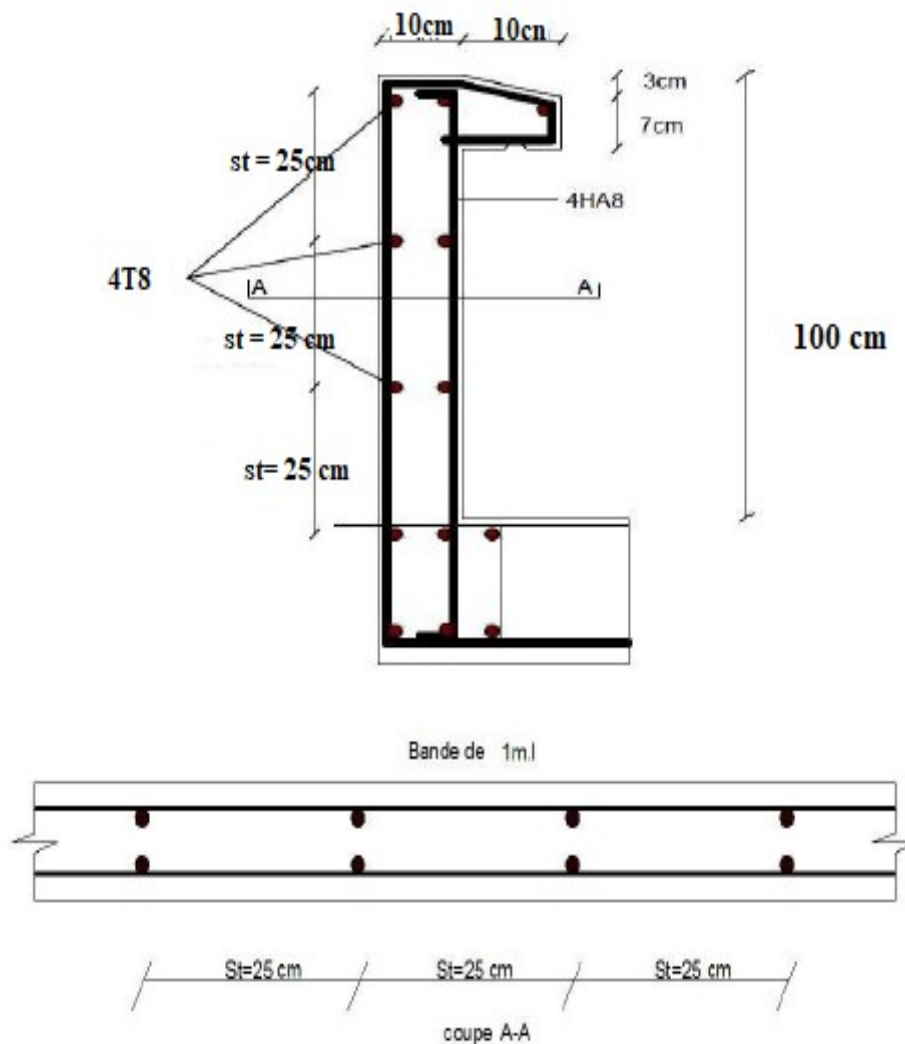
schémas de ferrailage d'acrotère.
